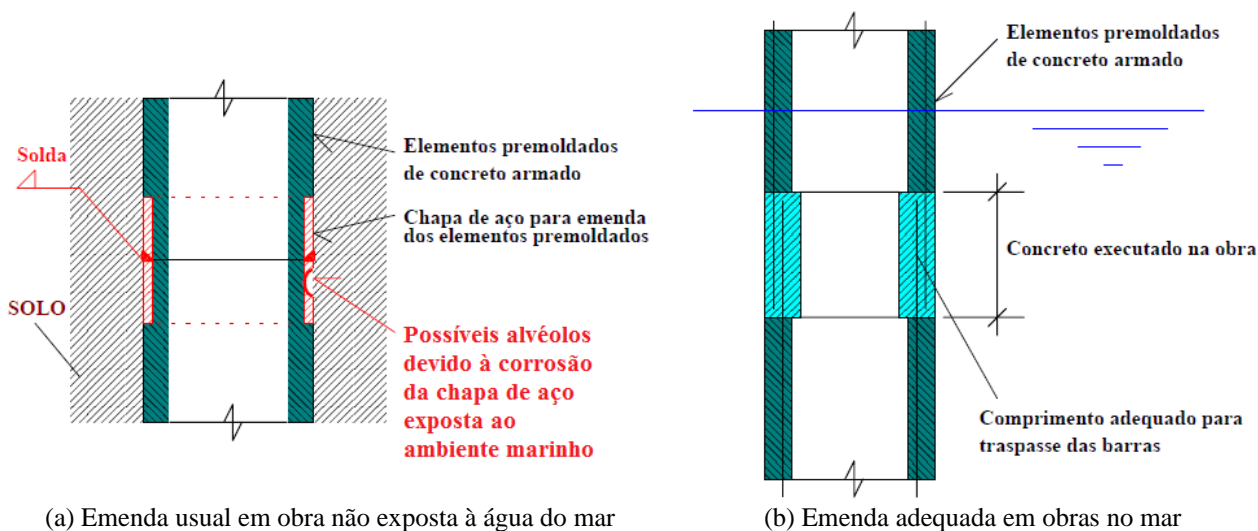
Detalhe de emendas estruturais de chapas soldadas em estacas premoldadas de concreto
